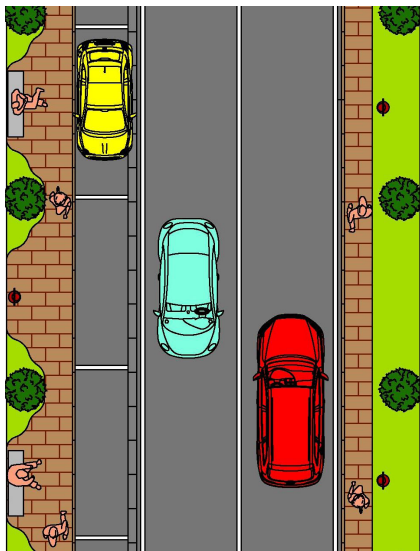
Planimetria progettuale con ipotesi strada a doppio senso di marcia
